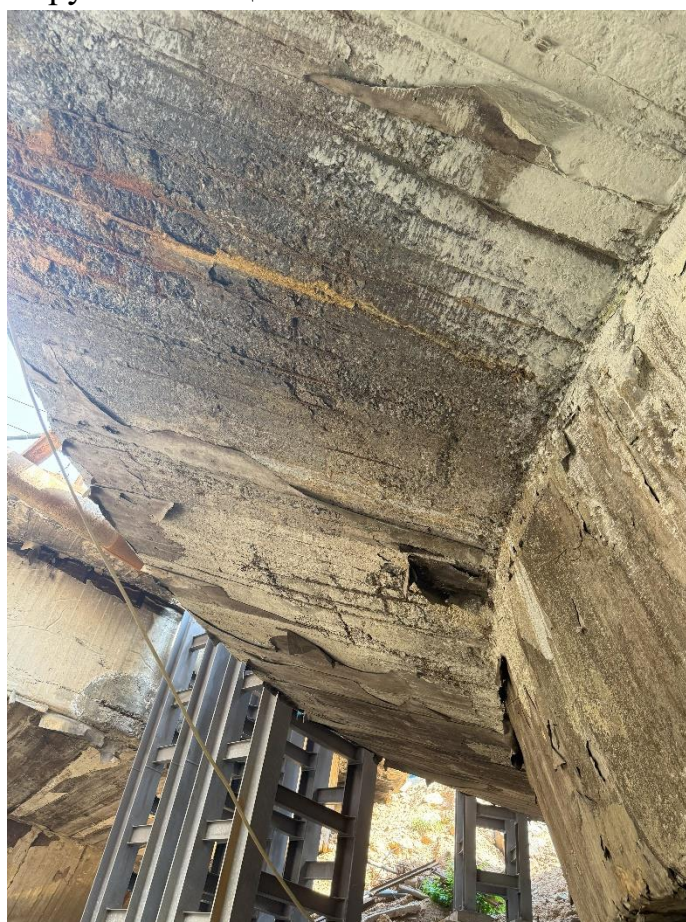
Разрушение наружной гидроизоляции чаши. Разрушение наружного защитного слоя бетона чаши
